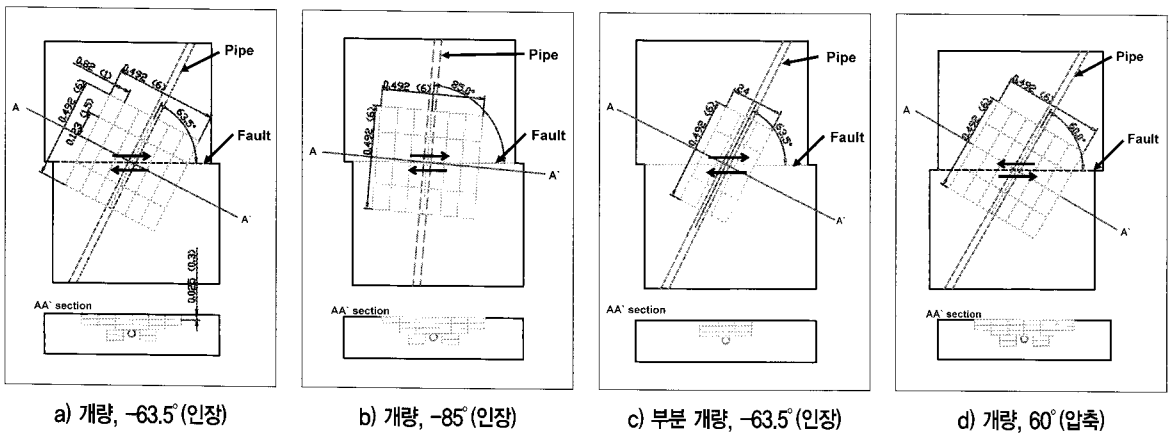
지반 개량 모델의 평면도 및 단면도 (Choo 등, 2007)
